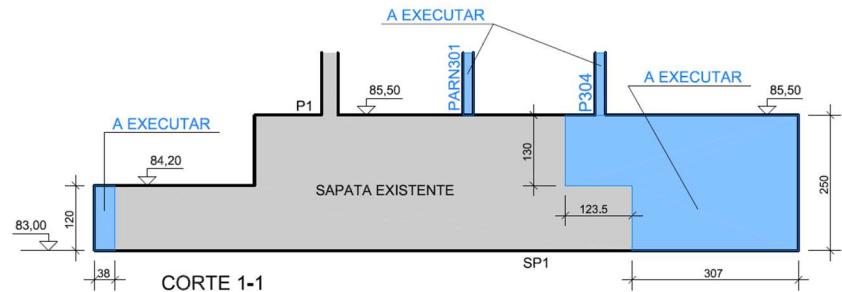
Detalhamento da nova estrutura a ser executada. Vista em perfil.
